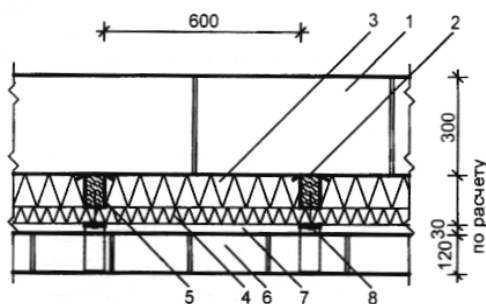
Вентилируемая стена с облицовкой кирпичом (горизонтальное сечение):
